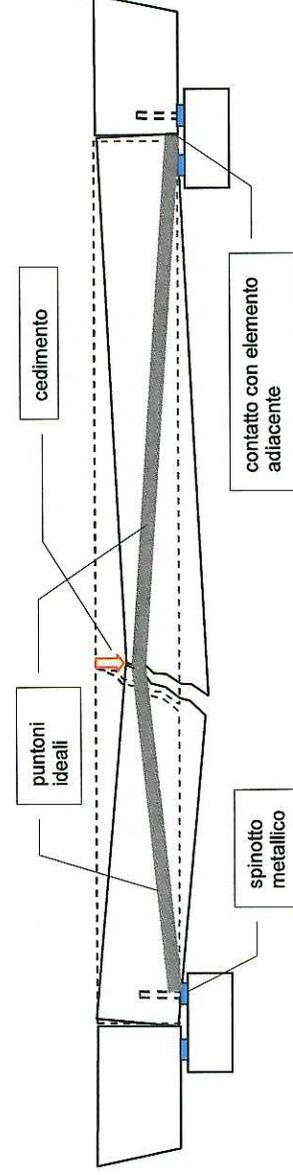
Schema resistente (non affidabile) di un elemento di pontile dopo il cedimento dell'armatura di precompressione e la formazione della fessura.
